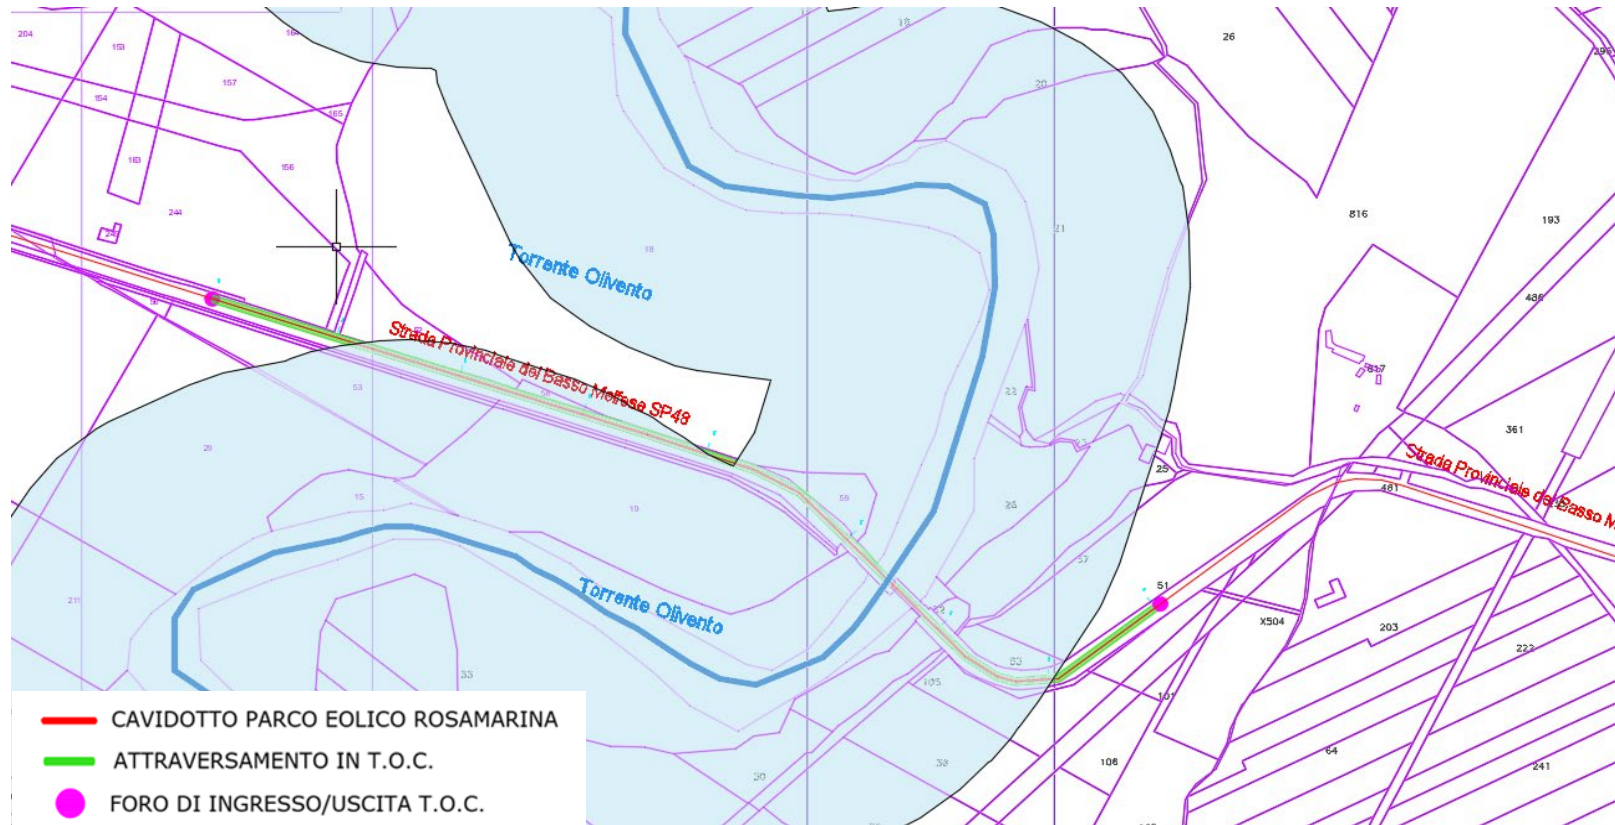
Stralcio planimetrico su catastale con indicazione del tratto di cavidotto da realizzare in T.O.C in corrispondenza del torrente Olivento
